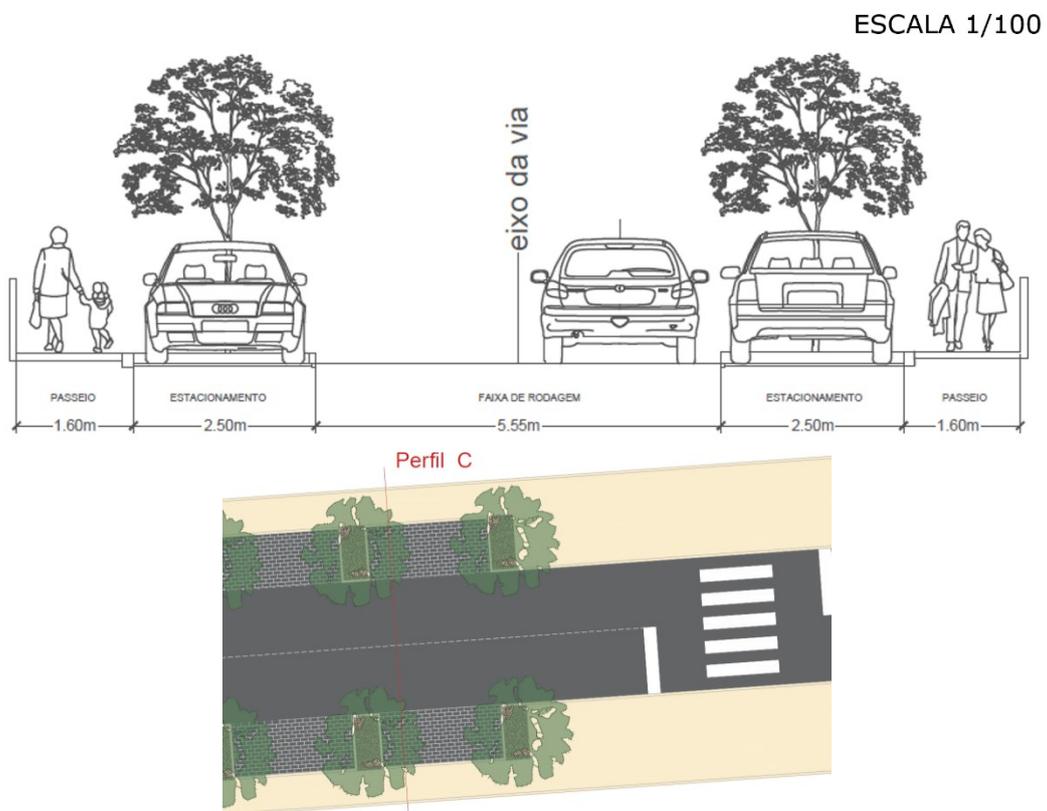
Perfil proposto para a Rua João Vaz Corte Real e Rua Tristão Vaz Teixeira – Perfil C
